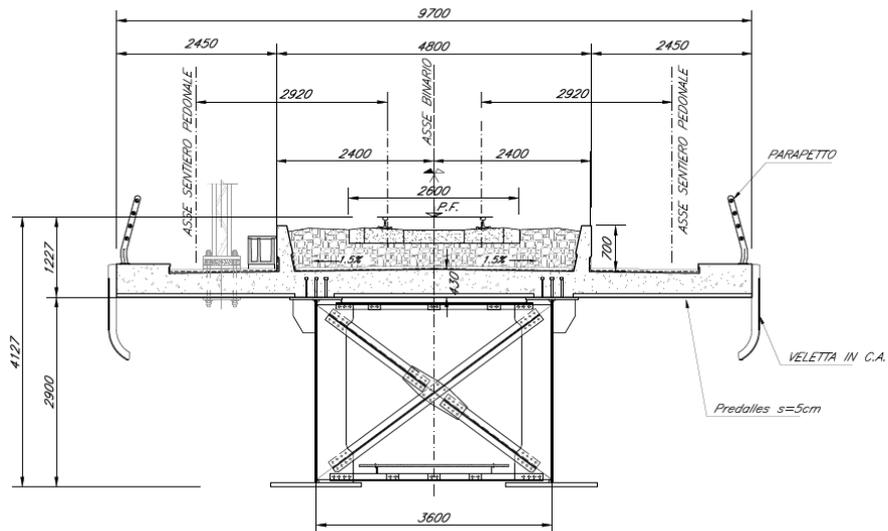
Sezione trasversale impalcato da 40m a singolo binario
